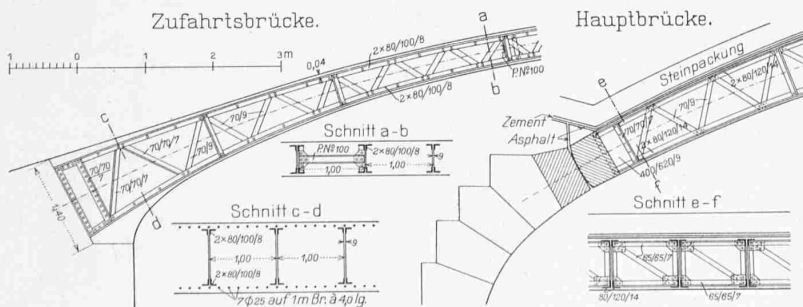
I. Preis. — Details der Bogenkonstruktionen. — Masstab 1 : 100.
